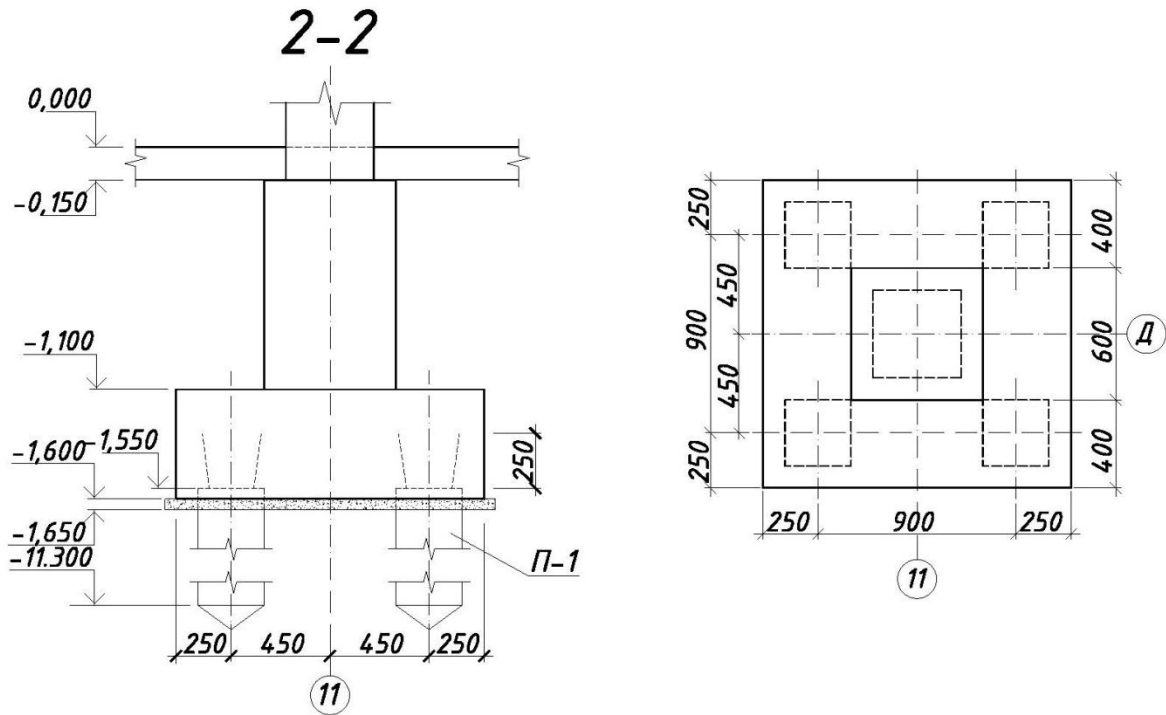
Конструкція стовпчастого фундаменту колони типу КМ-2.3. на перетині осей 11 та Д (4 палі)
